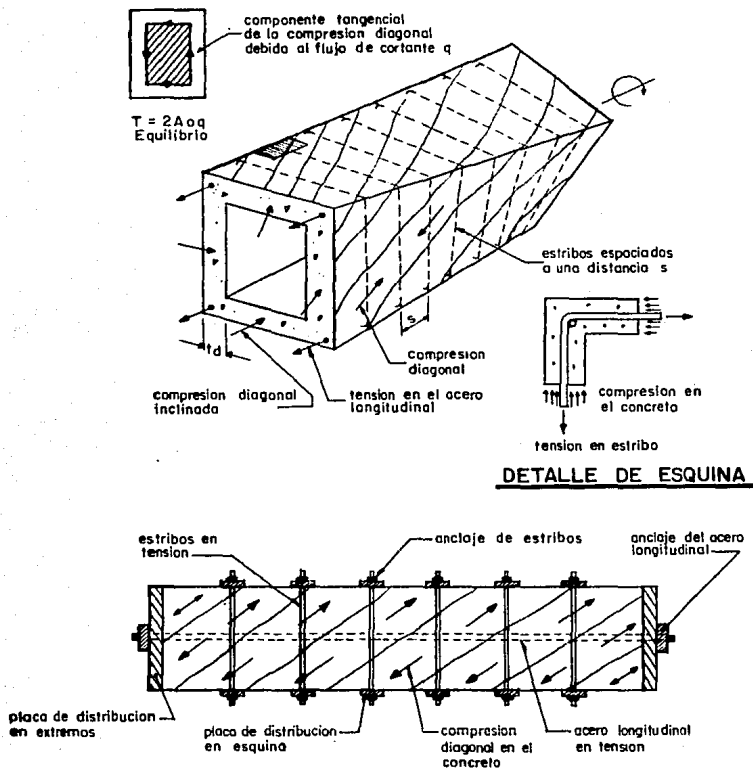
Funciones idealizadas del concreto y del refuerzo después del agrietamiento por torsión.
